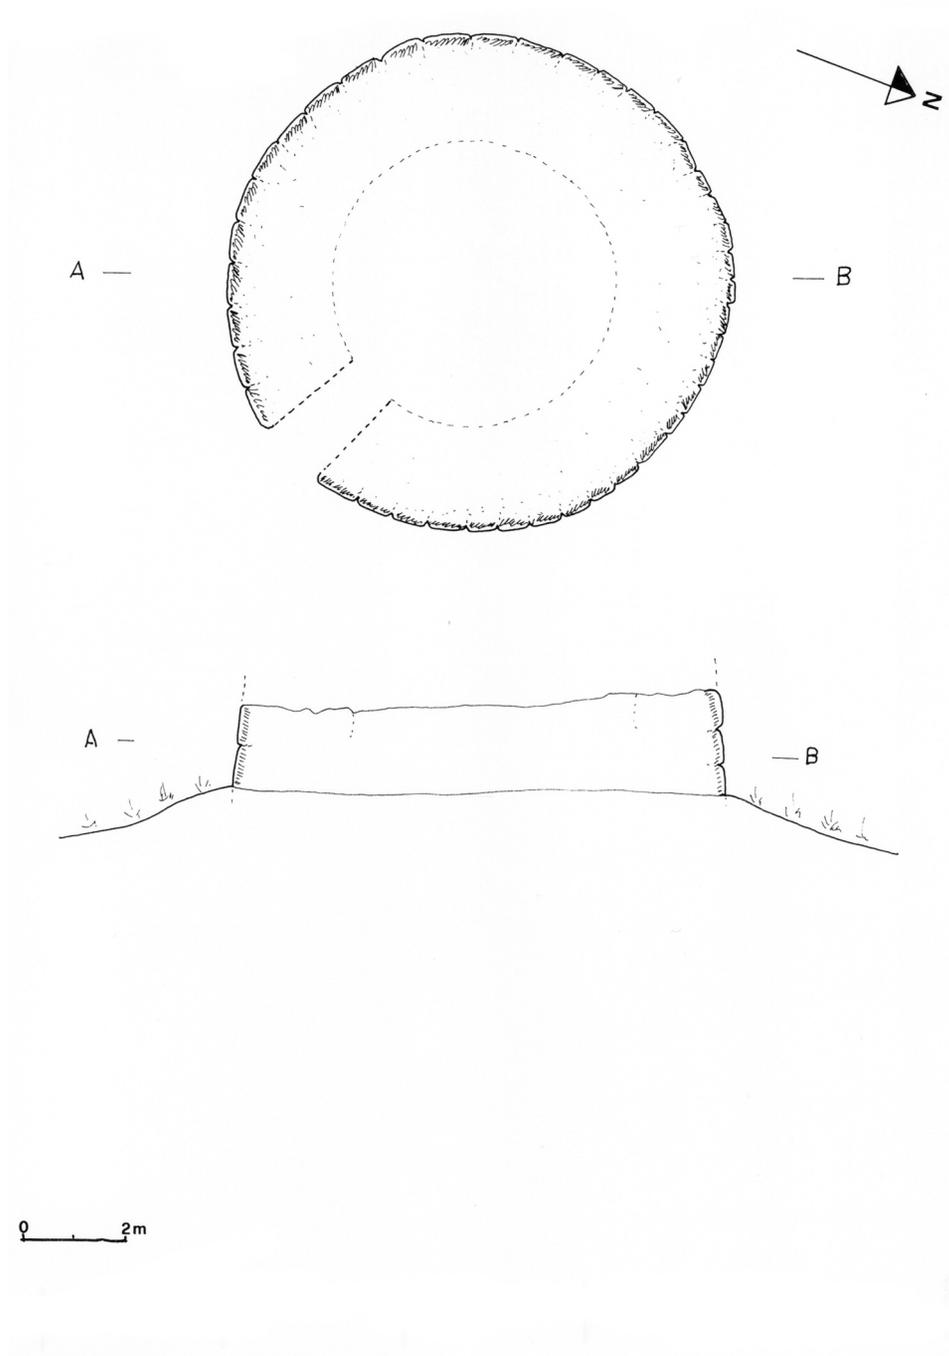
Brughitta*: planimetria e sezione del nuraghe monotorre.
